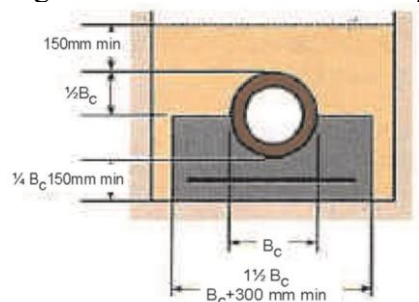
Zonë rrethuese me beton të papërforcuar
